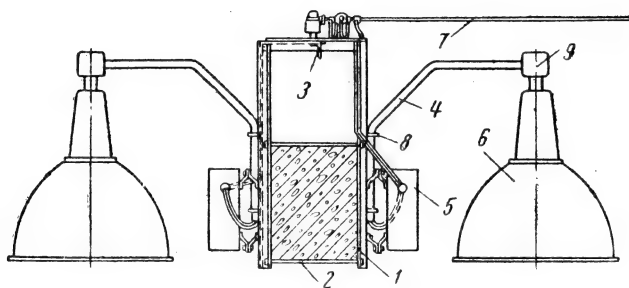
Крепление светильников и проводки на изоляторах к нижнему поясу железобетонных ферм.
